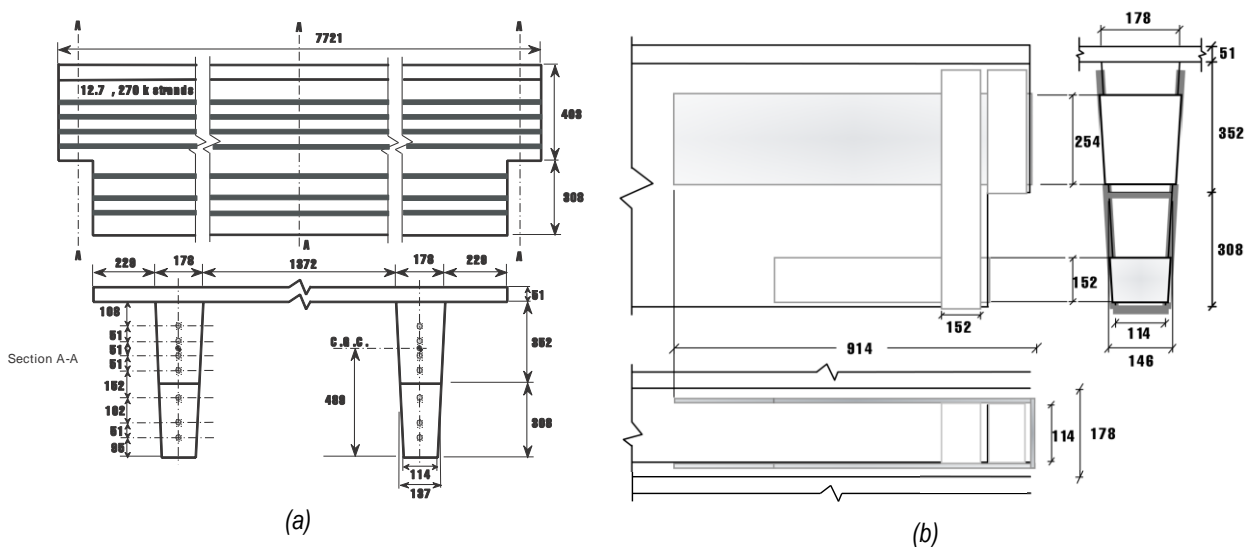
AMM ensayados por Huang y Nanni [56]: (a) Geometría y detalle de armadura pasiva; (b) Esquema de refuerzo con CFRP's
